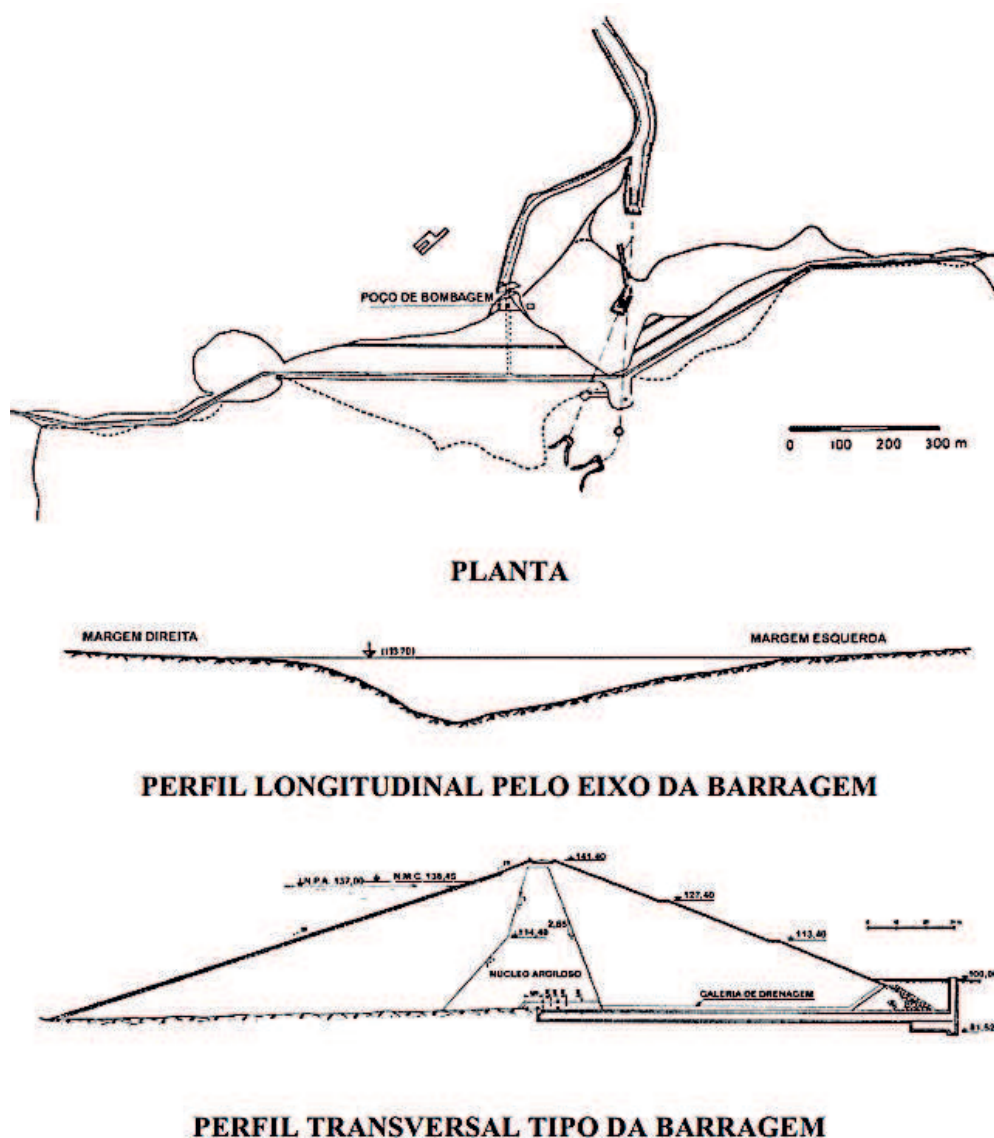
Projeto Barragem Monte da Rocha (Planta, perfil longitudinal e perfil transversal), (<http://sir.dgadr.pt>).
